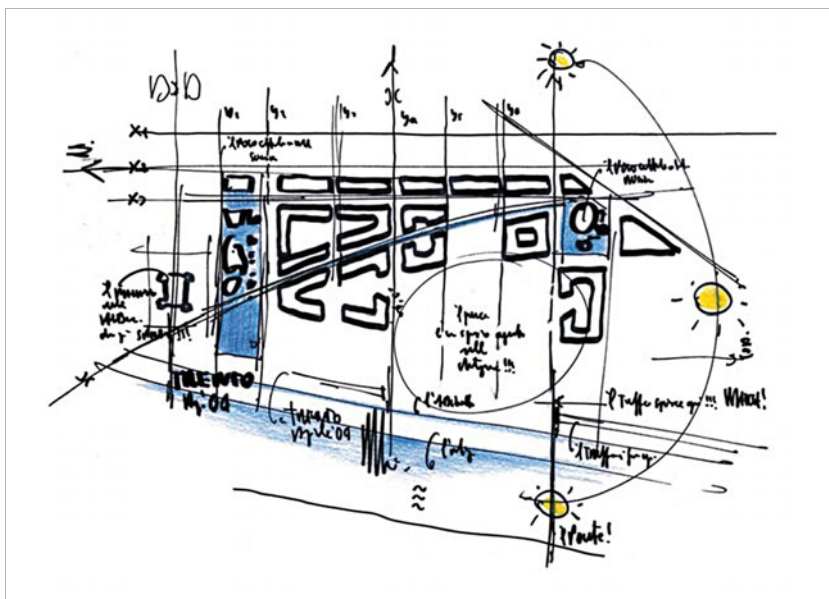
Renzo Piano. Schizzo di progetto. Fonte: [www.rpbw.com](http://www.rpbw.com). Accesso: 01/02/2016.
